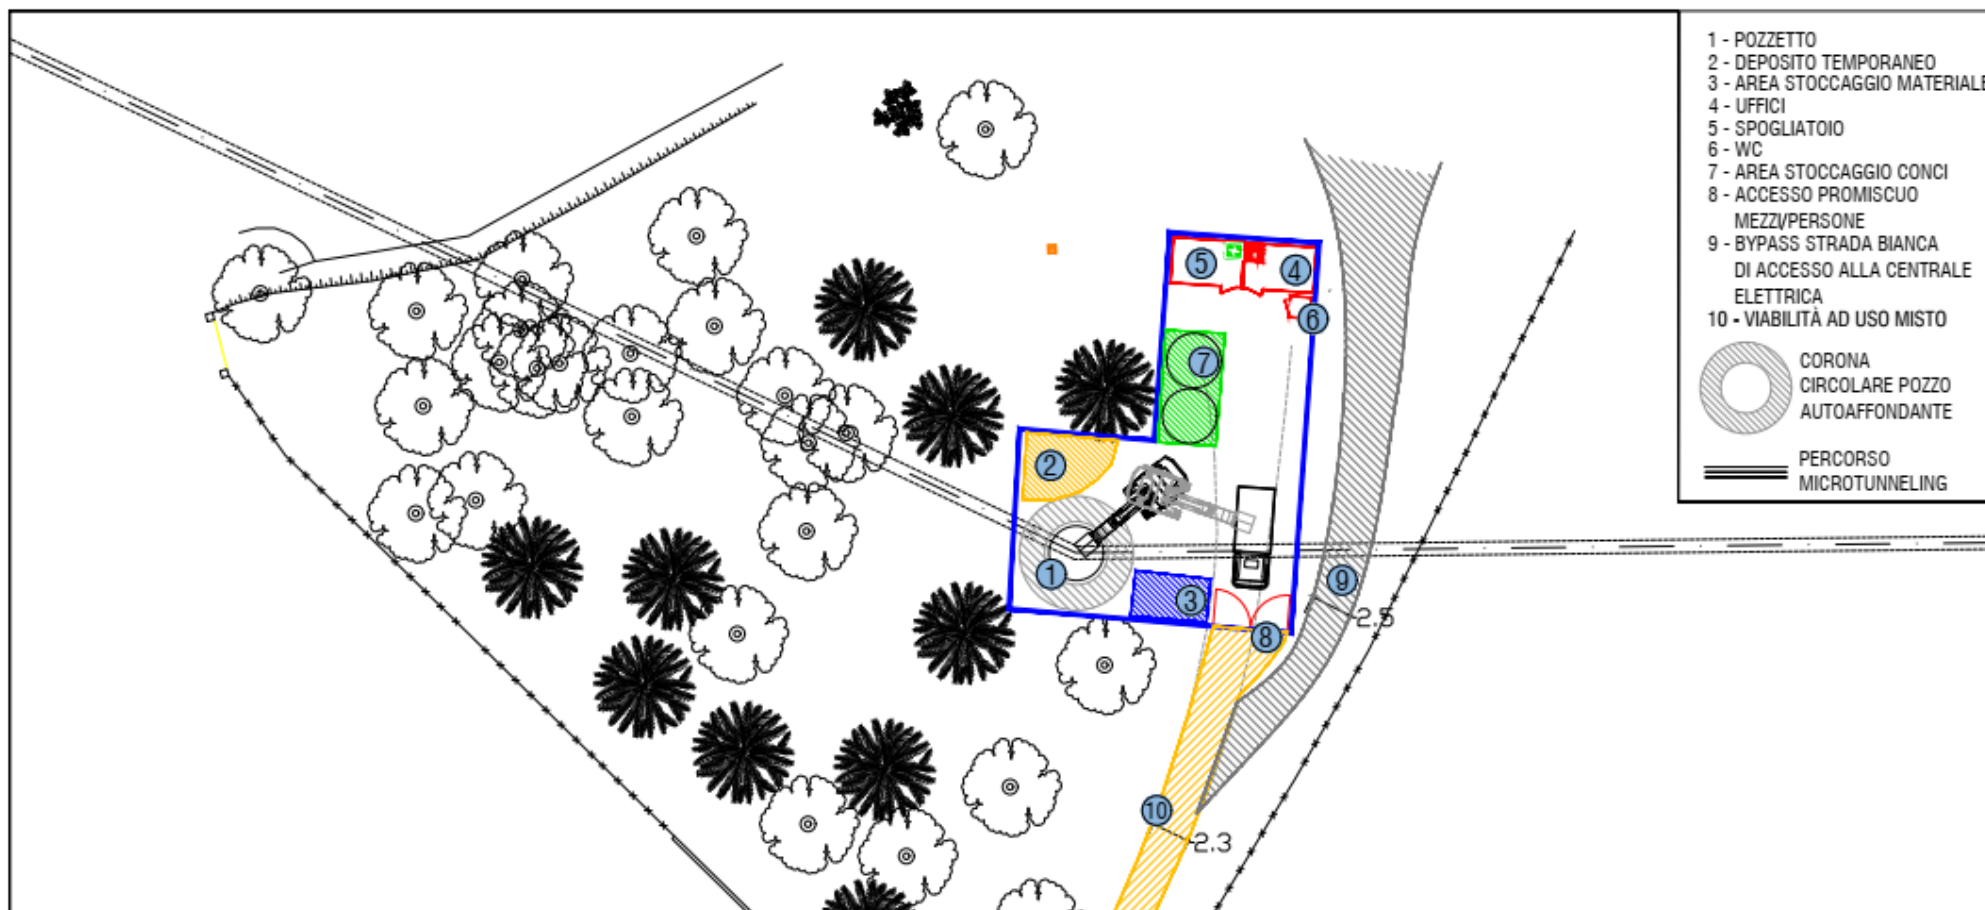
D : Schema cantiere microtunnelling pozzo di spinta S2b – DN800
